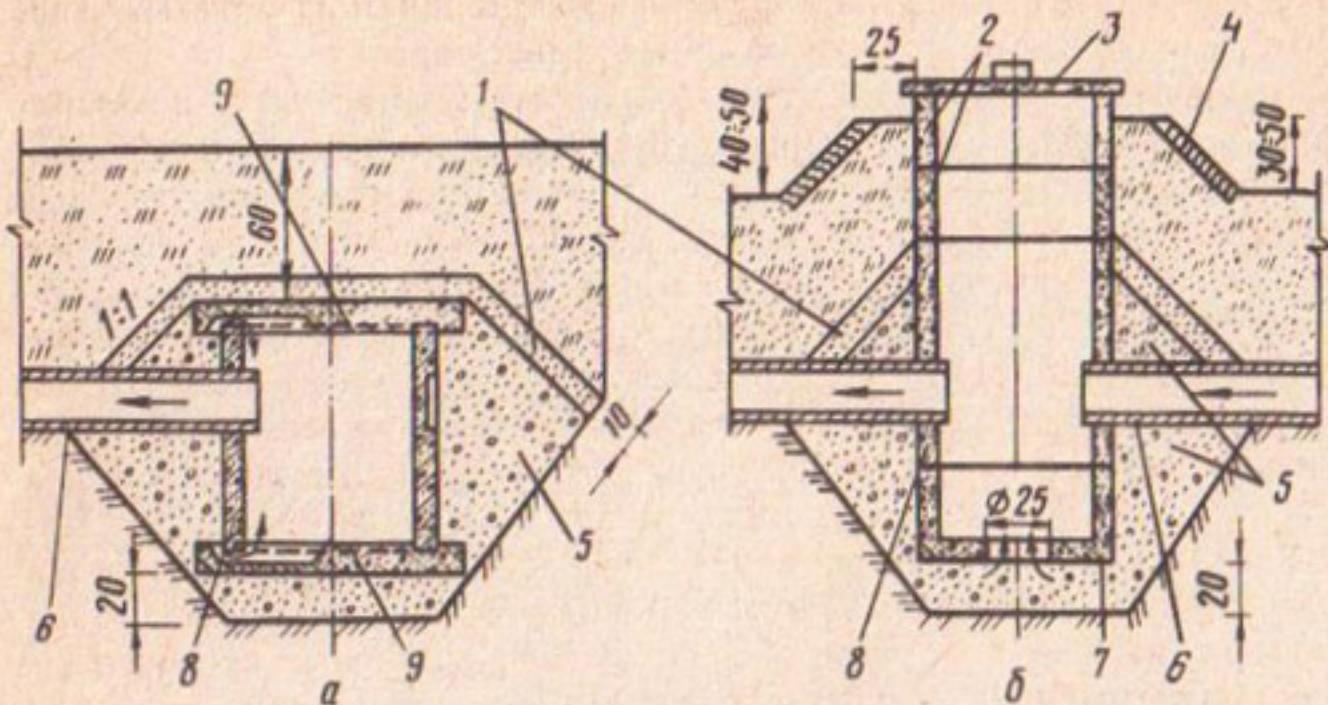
Дренажные фильтры для перехвата напорных грунтовых вод:
